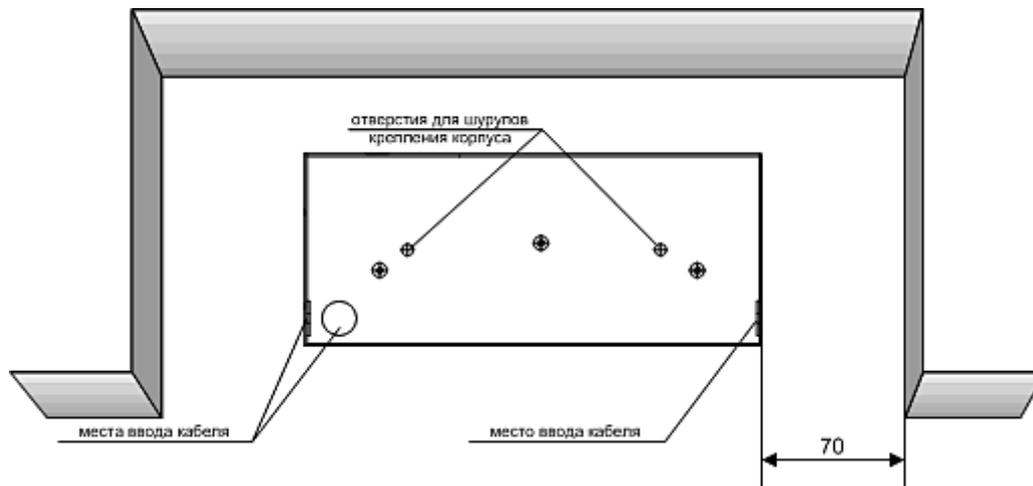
Расположение корпуса КСП-А4/8 и ИСА-8 при монтаже
